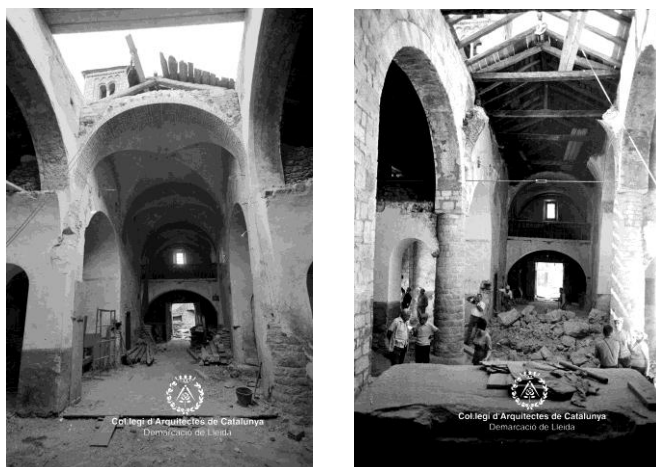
Taull. Iglesia de Santa María AFAFV. Fotografías del desmontaje de muros transversales y recuperación de pilares circulares y pinturas murales
